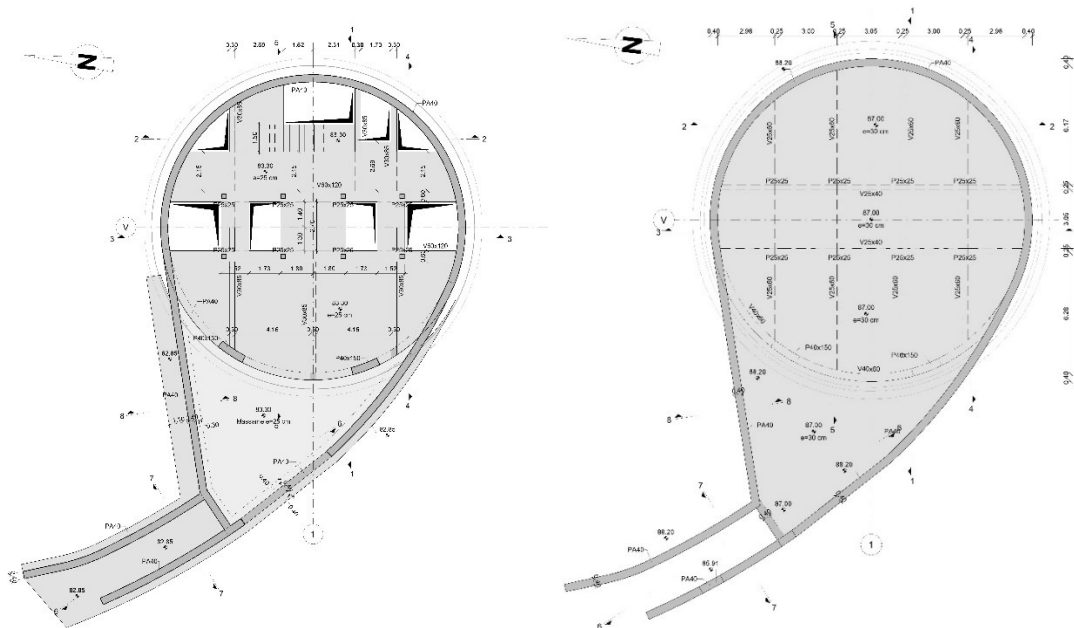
Planta da cobertura da estrutura definitiva do poço.
